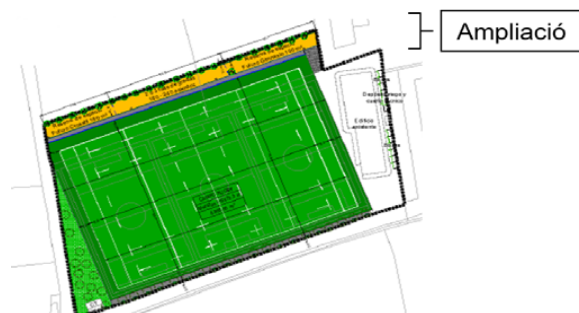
Planta prevista para la implantación del nuevo campo de rugby.
